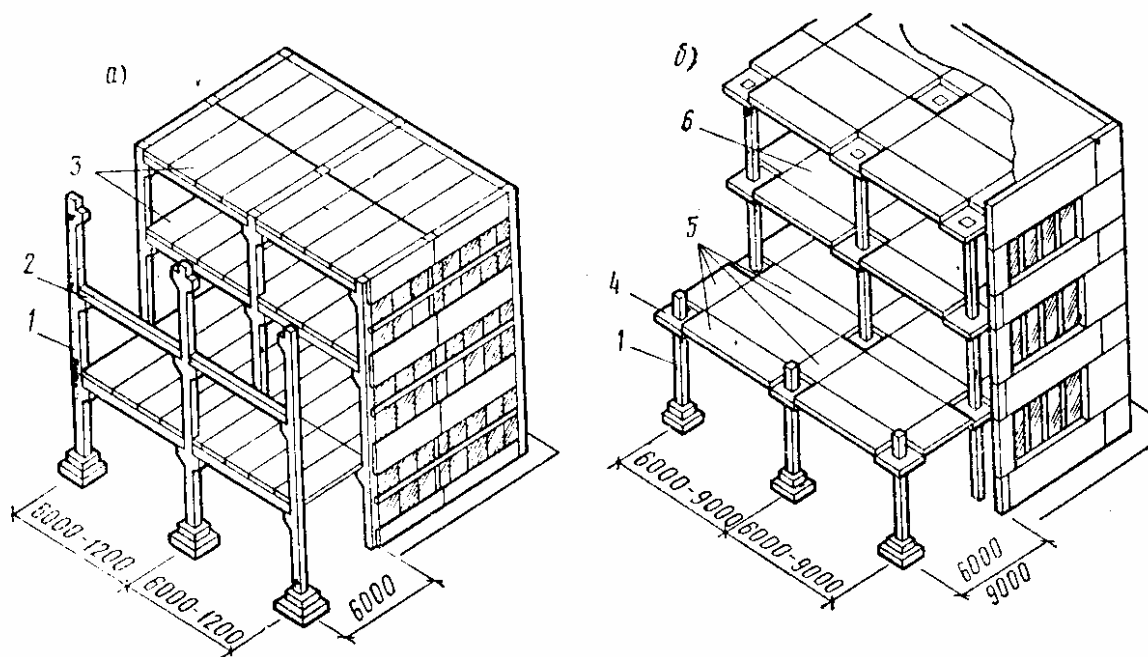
Конструкции каркасов многоэтажных промышленных зданий: а – балочная; б – безбалочная; 1 – колонна; 2 – балка; 3 – панель перекрытия; 4 – капитель; 5 – надколонные плиты; 6 – пролетная плита
